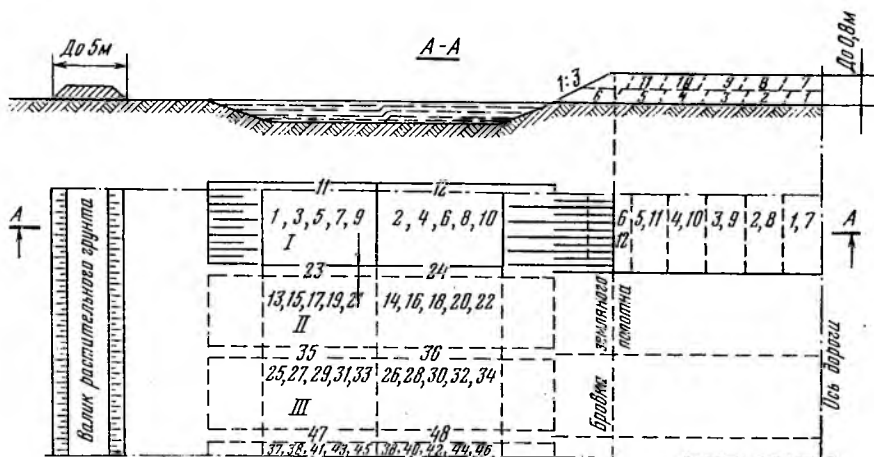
Схема траншейной разработки грунта в боковых резервах с перемещением его в насыпь бульдозером:
